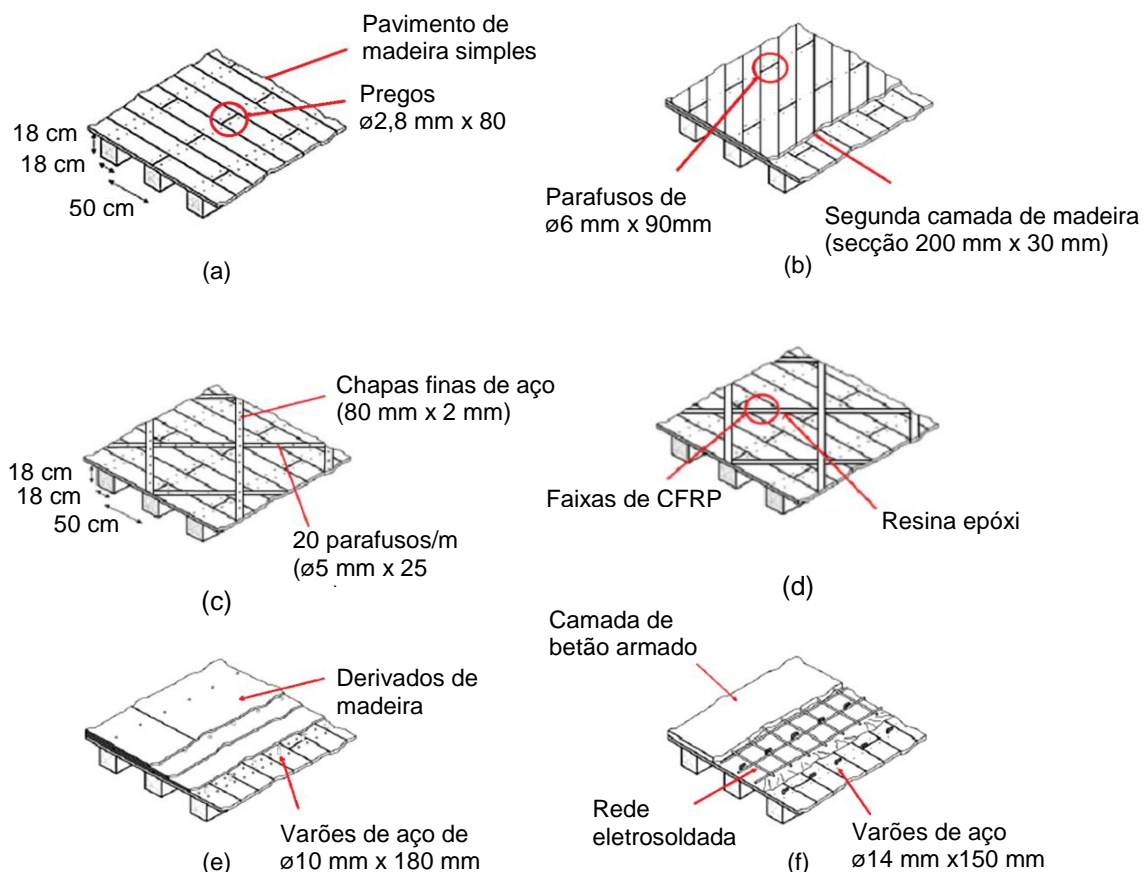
Diversas soluções de pavimento (adaptado de Piazza, et al., 2008)
